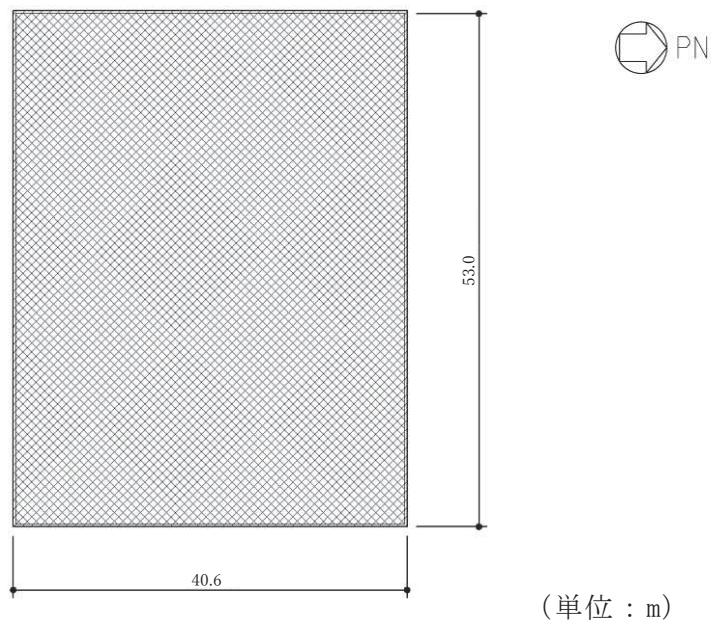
(6) 原子炉建屋原子炉棟（二次格納施設）の範囲の平面図
